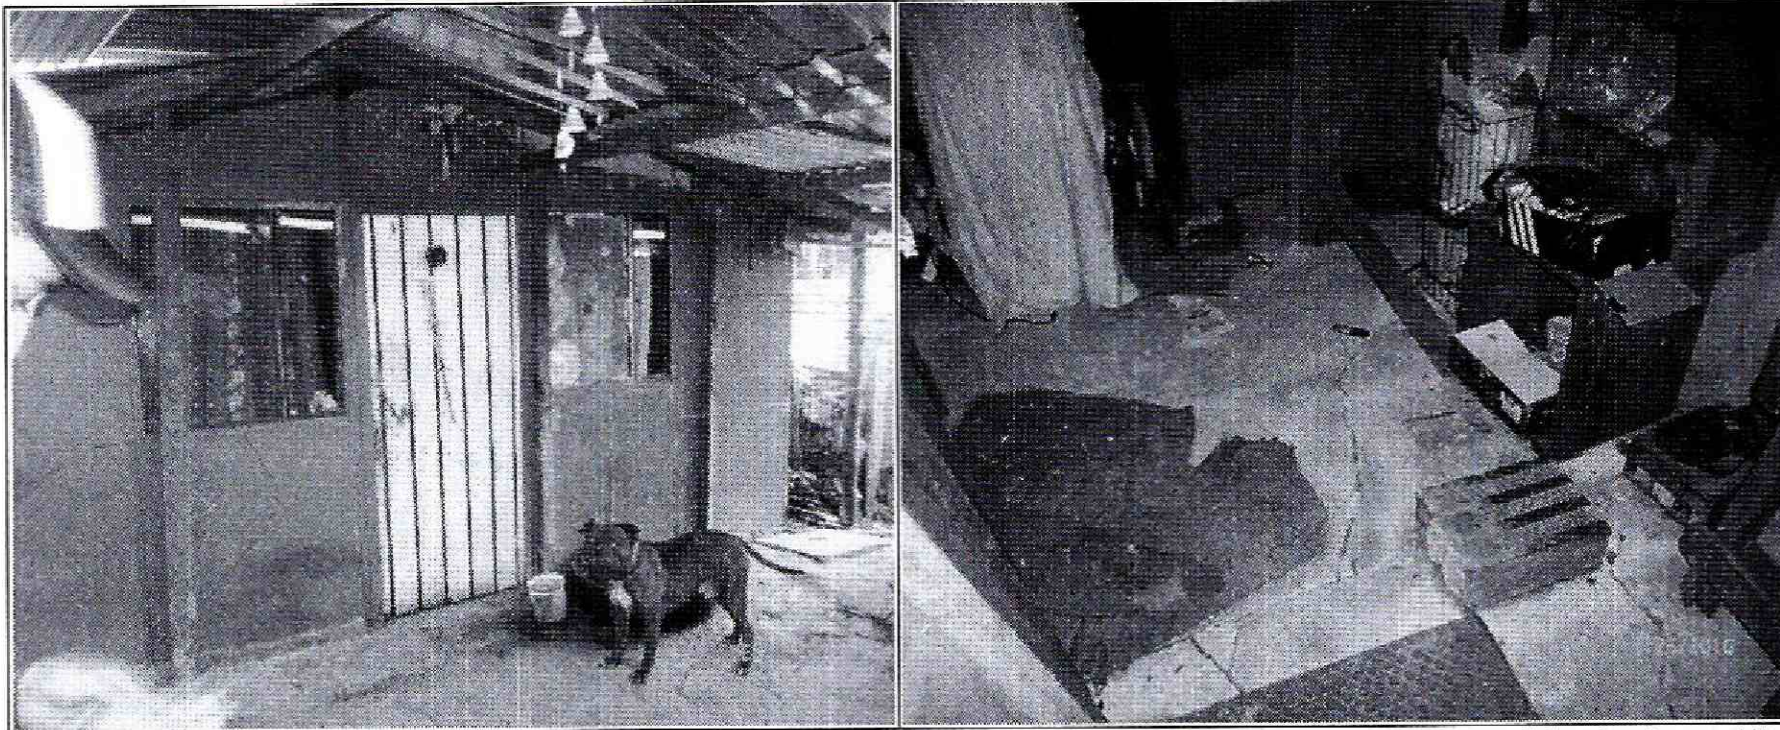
y 2. Predio de la Calle 46D Sur No 16C-96 Este, se emplaza una vivienda de 1 (un) nivel, construida en mampostería simple con cubierta liviana en tejas de asbesto cemento soportadas por un entramado en madera que a su vez se apoyan sobre los muros perimetrales y muros de cerramientos en bloques de arcilla.
